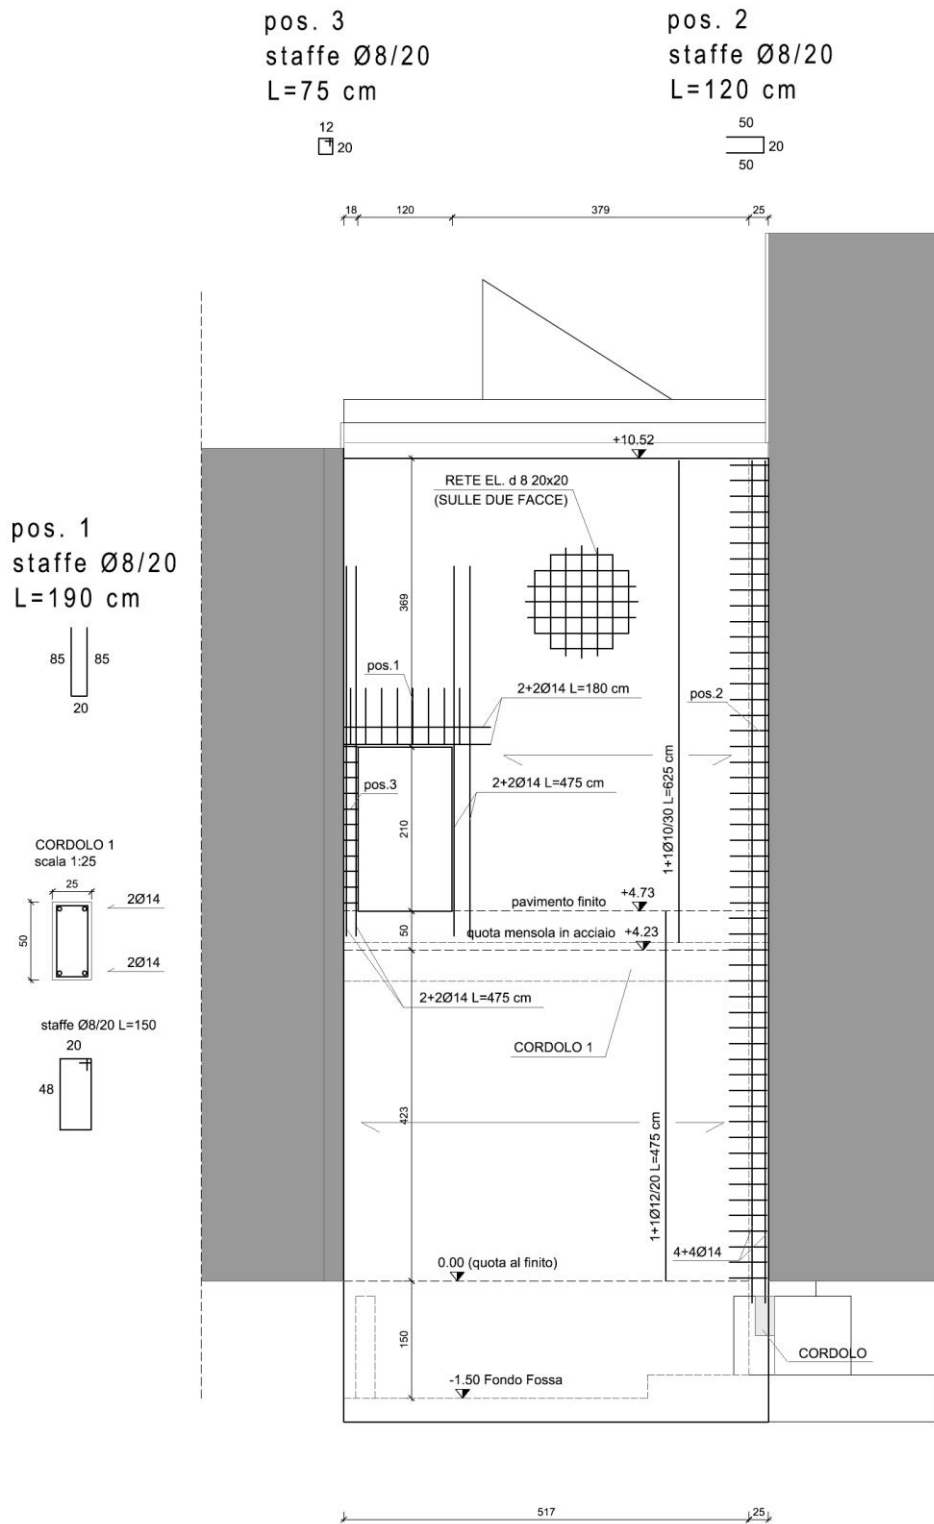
Particolare di A.2003.cap.us.T13 - Armature pareti nucleo 2 - Prospetto parete
